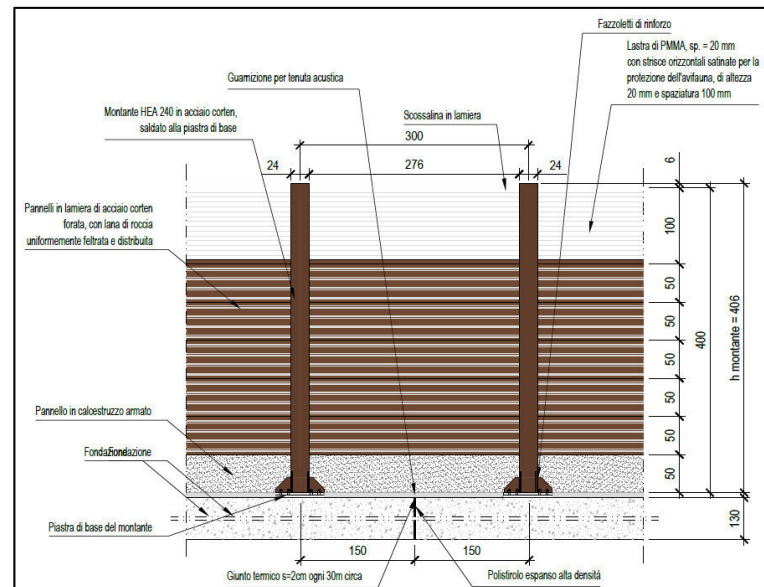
Prospetto delle barriere semitrasparenti da 4 metri
